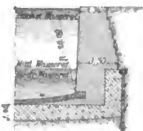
u. 238. Schutzschleuse. M. 1 : 200.
